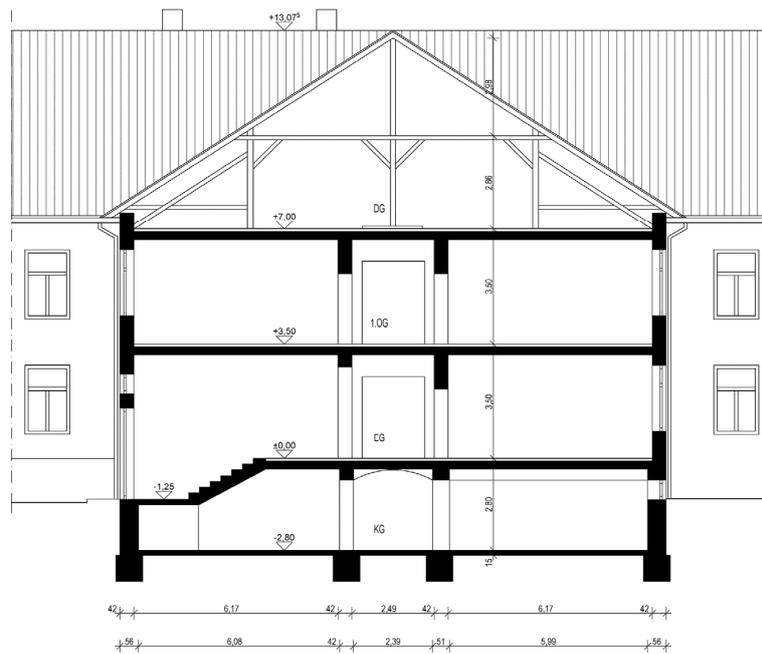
Schnitt durch ein typisches Gebäude der Klinker-Höfe
